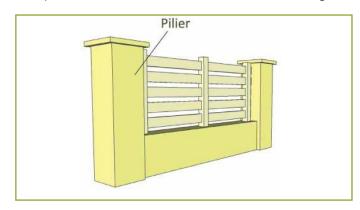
Schéma d'une section de mur avec piliers (Dessin de Cédric Houel)
